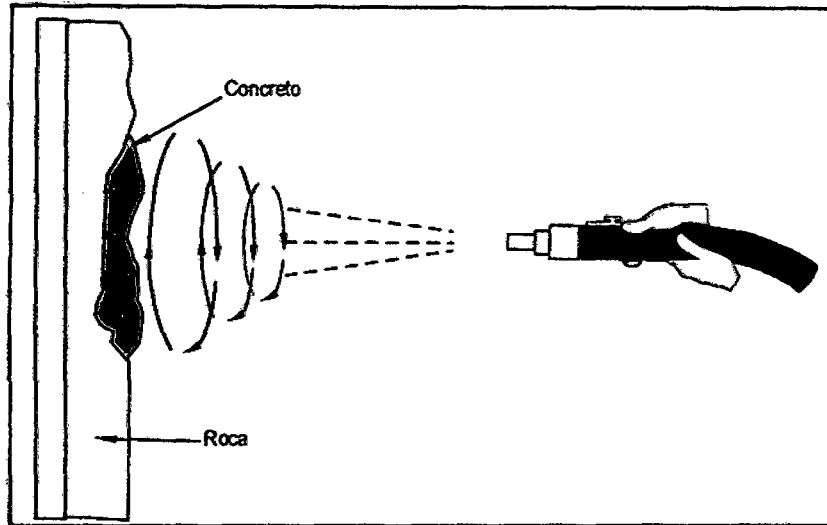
Posición de lanzamiento del shotcrete a las paredes (in. Consorcio Minero Horizonte)
